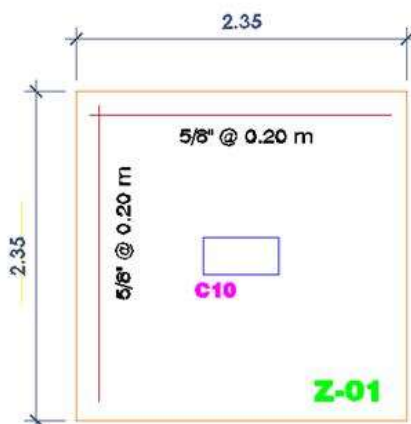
Distribución de acero en planta para la zapata de la Columna COL 10
